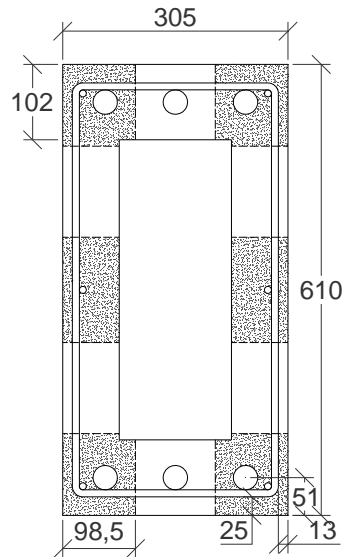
Sección transversal de la viga de ensayo CF1. Detalle de las áreas efectivas de la armadura pasiva longitudinal, según el criterio definido en el MC 1990. Cotas en mm.
